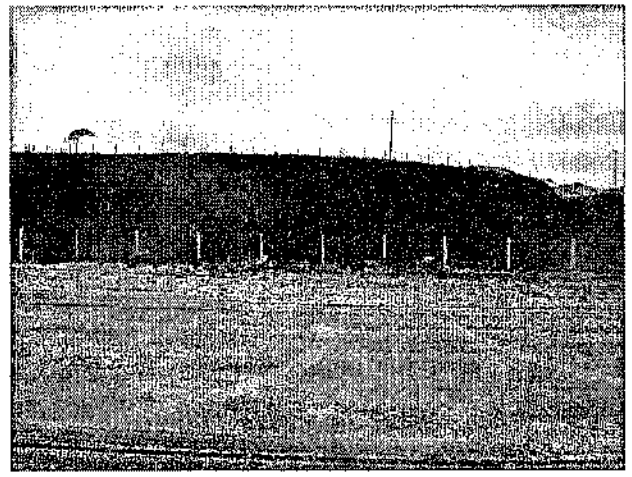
Lote 23/SC - Recuperação da Jazida Sorocaba
